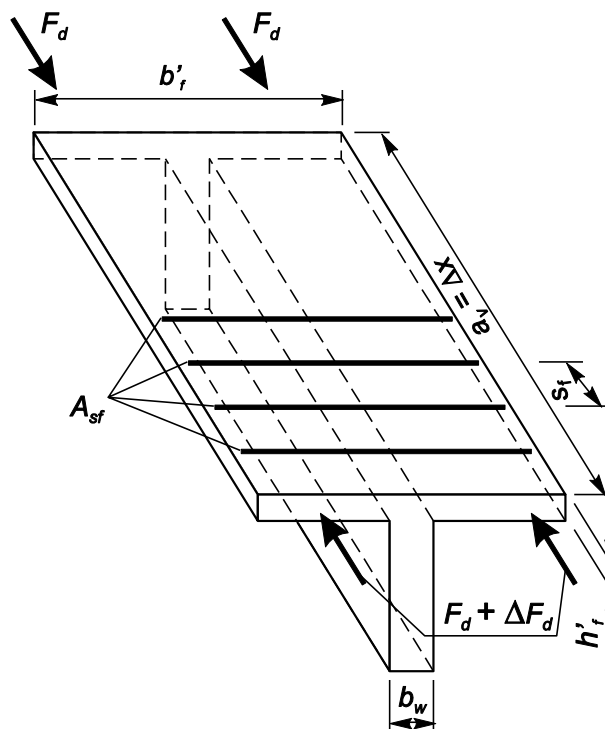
К расчету на срез между полкой и стенкой
